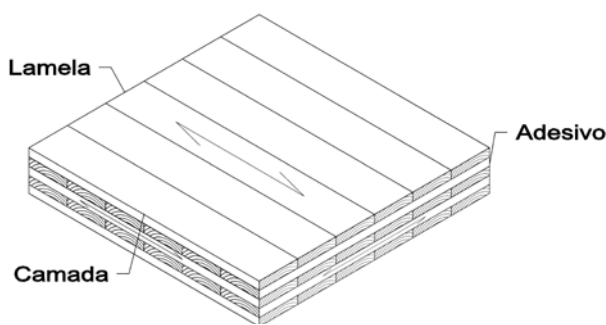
Representação esquemática de um painel de MLCC, com camadas alternadas ortogonalmente entre si e coladas com adesivo estrutural.
